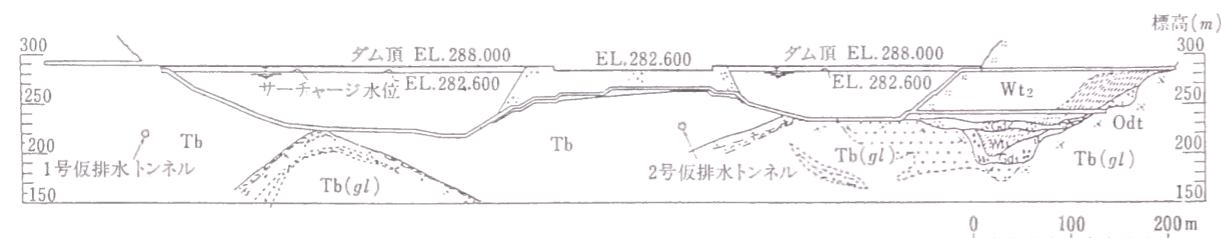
ダム軸・止水線地質断面図 (下湯ダム)
